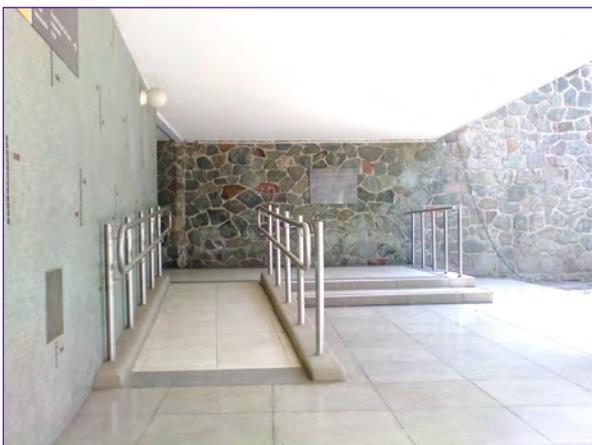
Estado actual de la rampa construida./ Elaboración propia.
